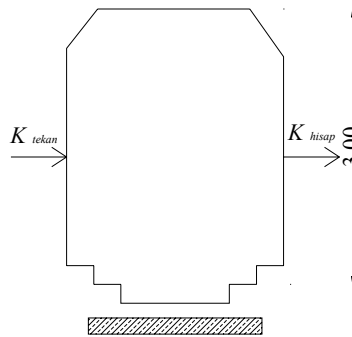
Pembebanan Ikatan Angin Sekunder Bawah
